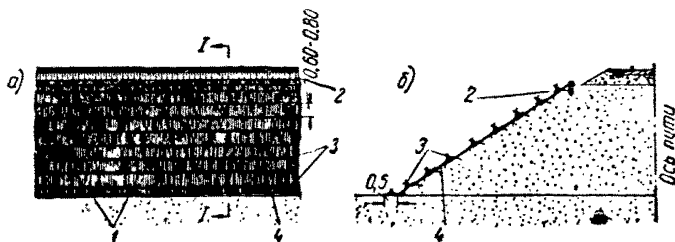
Укрепление откоса насыпи в районах распространения подвижных песков сплошным устилочным покрытием
